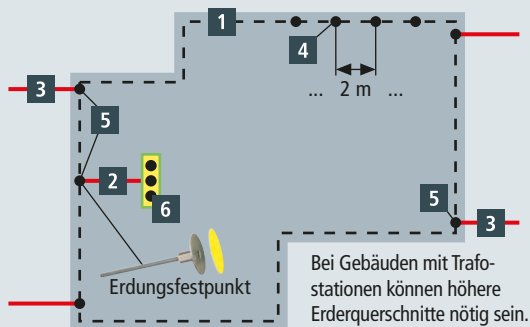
Fundamenterder mit Anschlussstück zum Blitzschutz und HES
